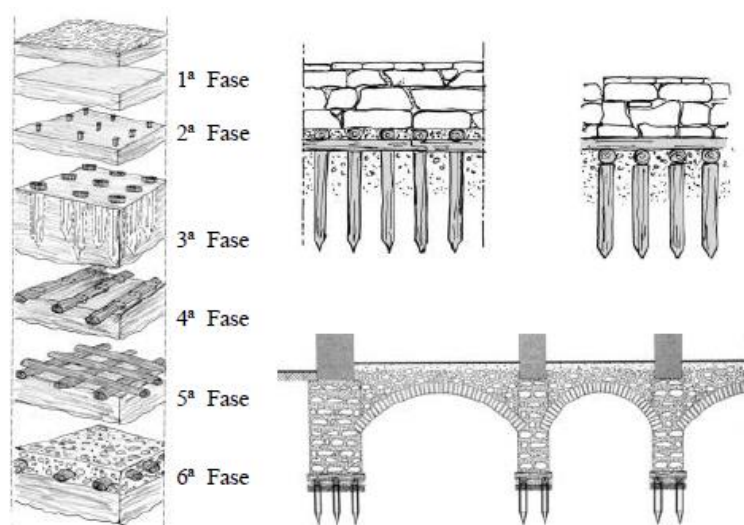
Fundações e pormenor das ligações entre paredes e pilares às fundações ^[3]
